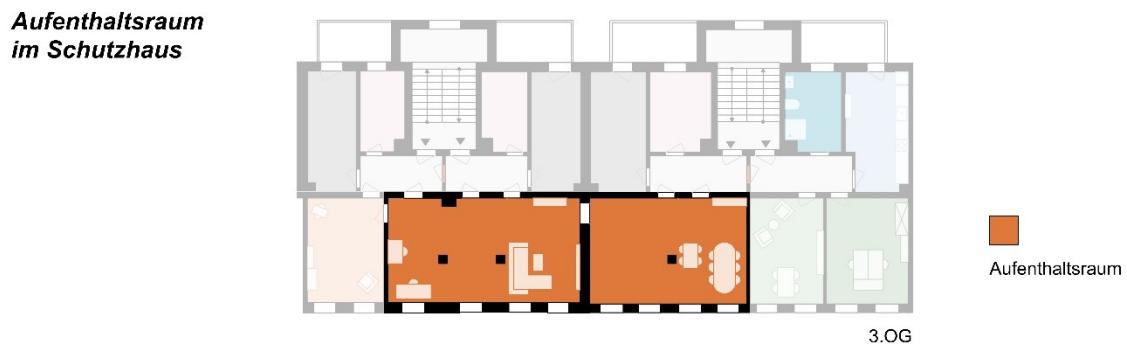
Beispiel Grundriss Schutzhause: Aufenthaltsräume im Dachgeschoss
